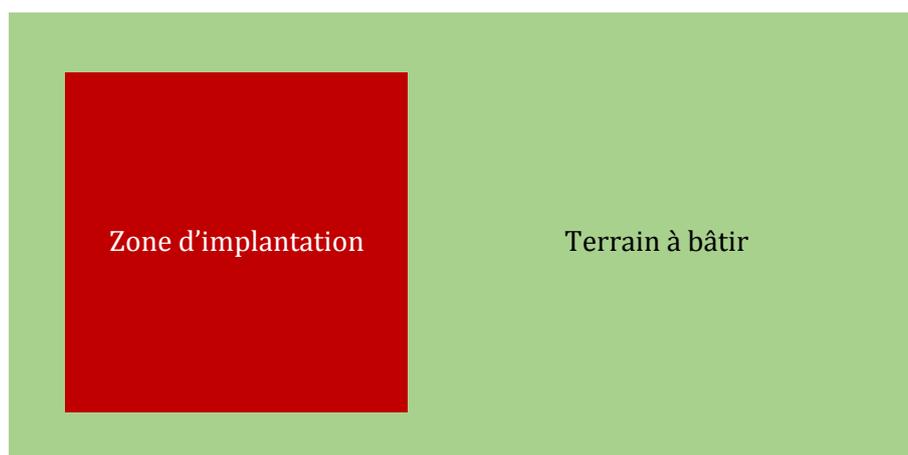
SCHÉMA DE LA ZONE D'IMPLANTATION SUR UN TERRAIN À BÂTIR (VUE EN PLAN)
